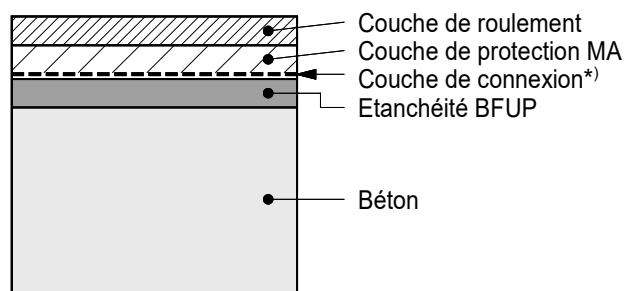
Système d'étanchéité BFUP pour projets et applications pilotes
